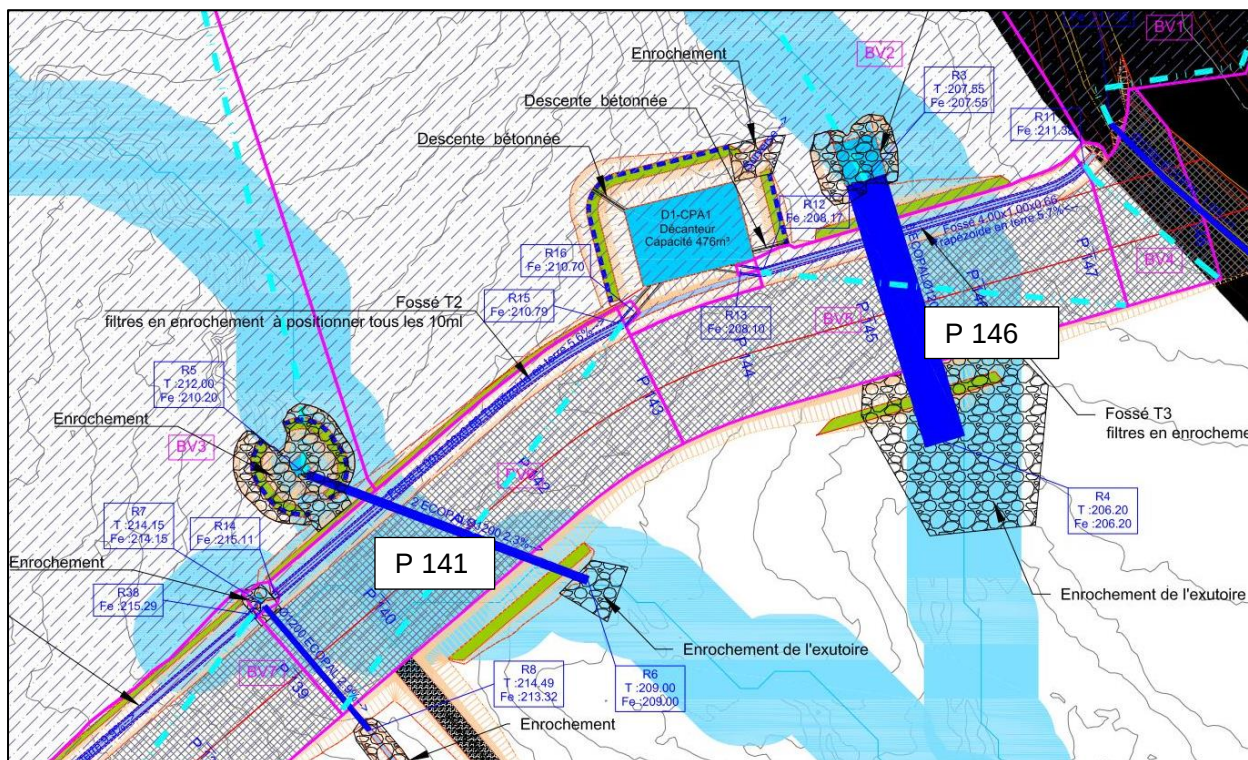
Extrait du plan de gestion des eaux de la piste d'accès – Traversées P141 et P146
